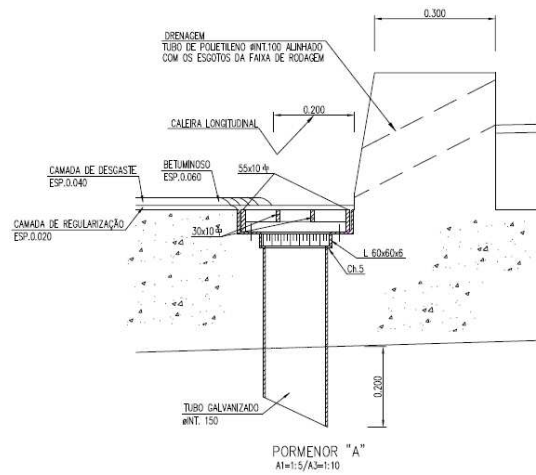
Pormenor tubo para esgotos do tabuleiro.
